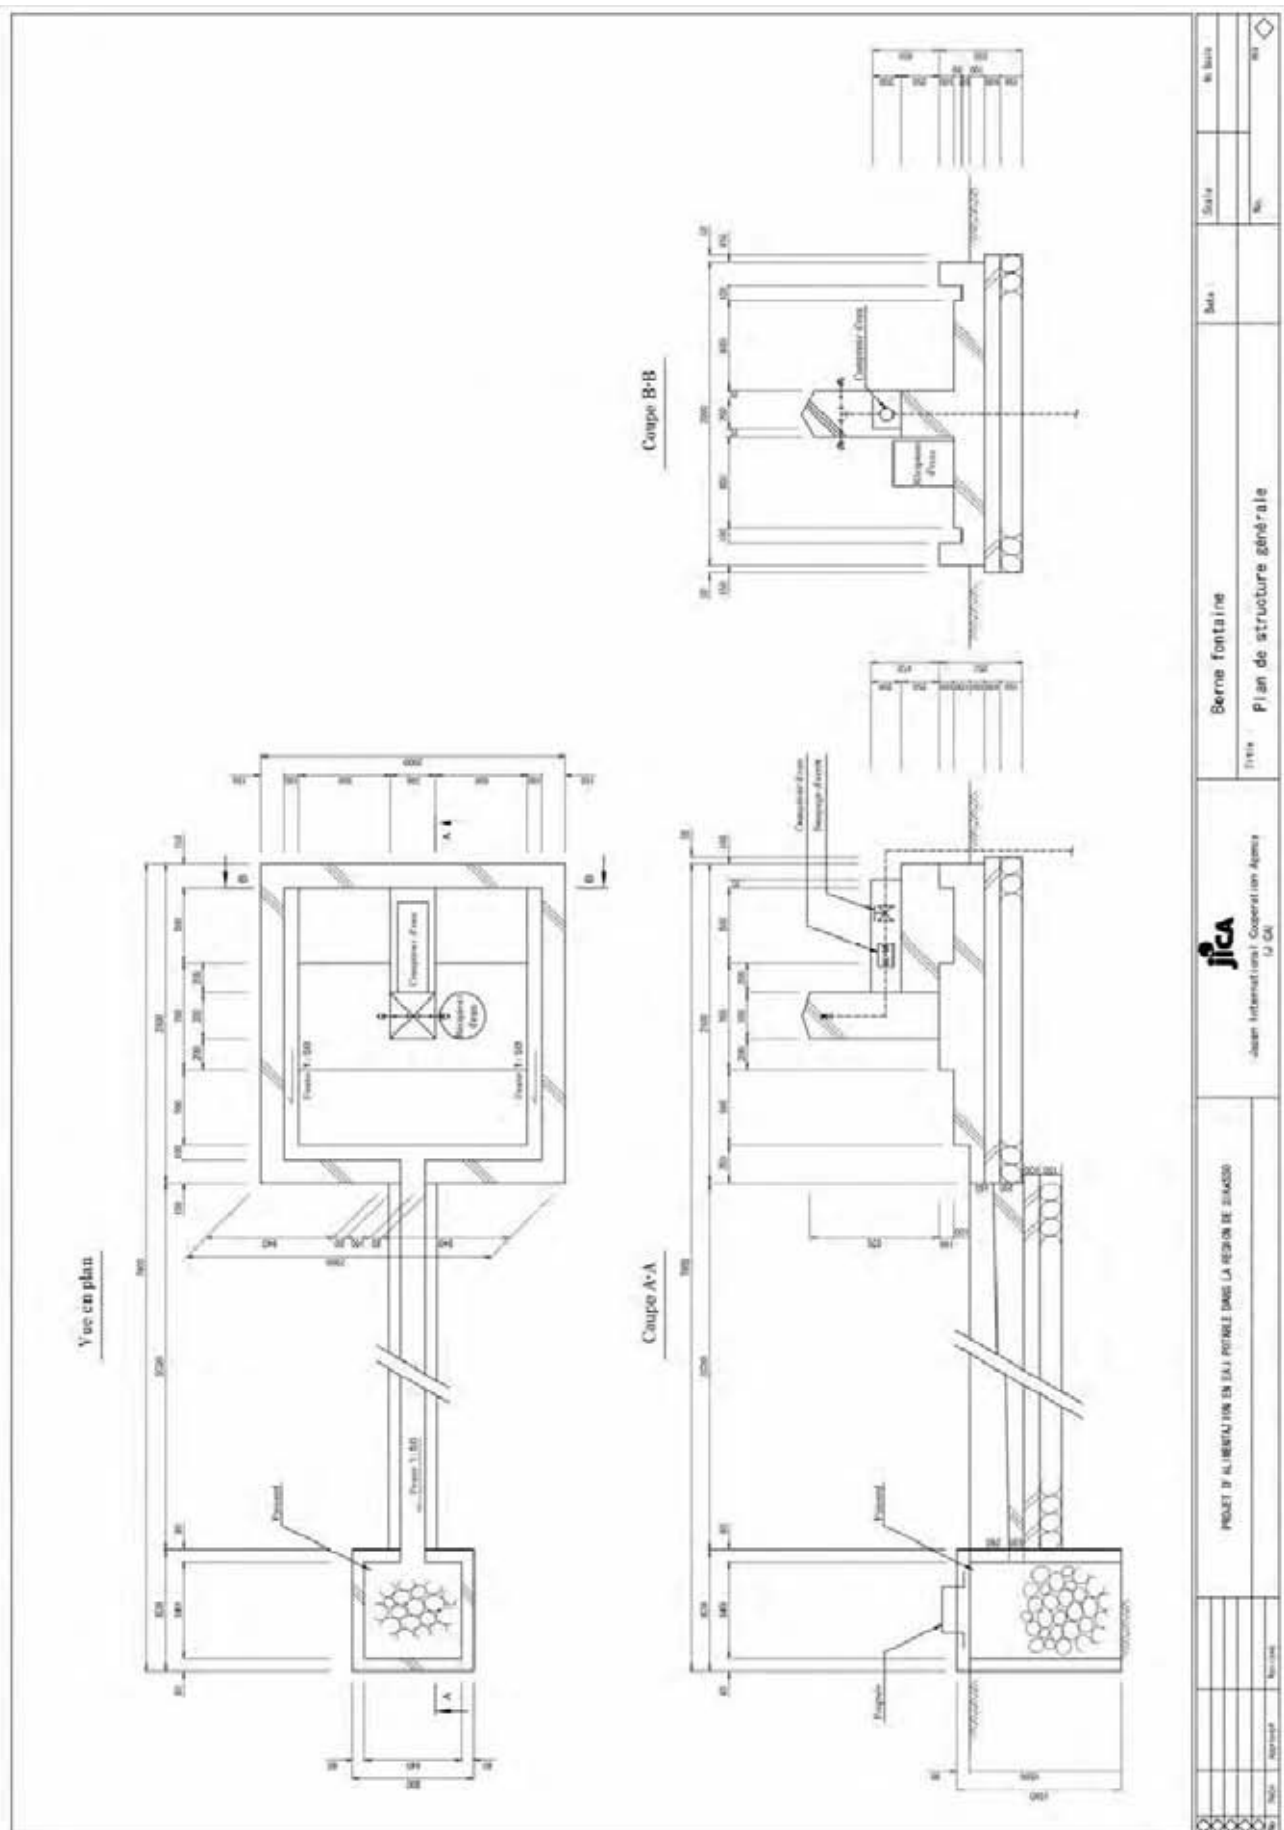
Système d'AES du Niveau 2 (Plan de masse type de la borne fontaine)
